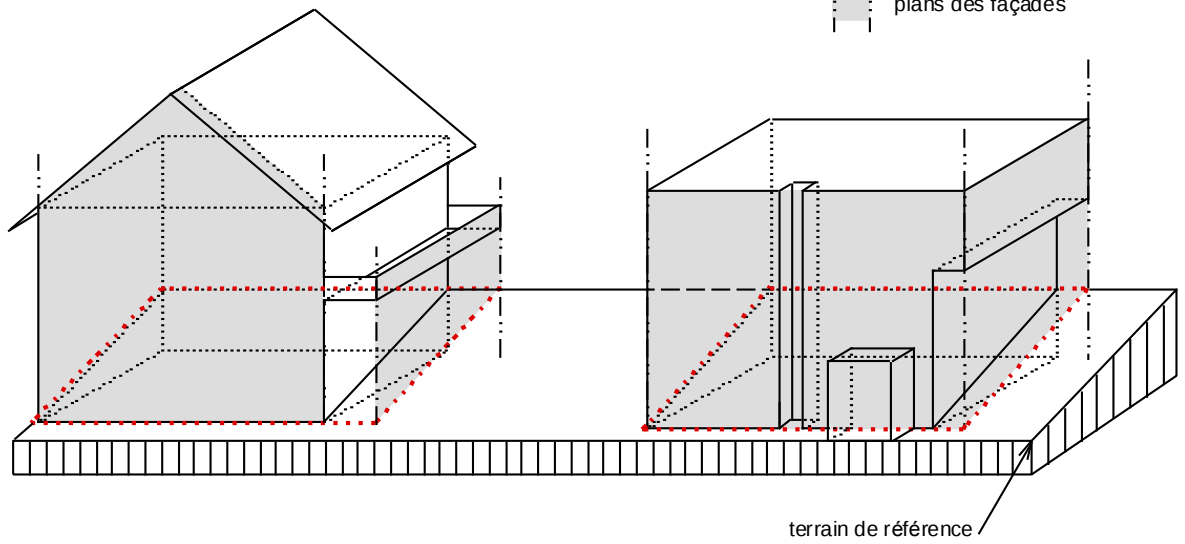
3.3 Plans des façades et projection du pied de façade
